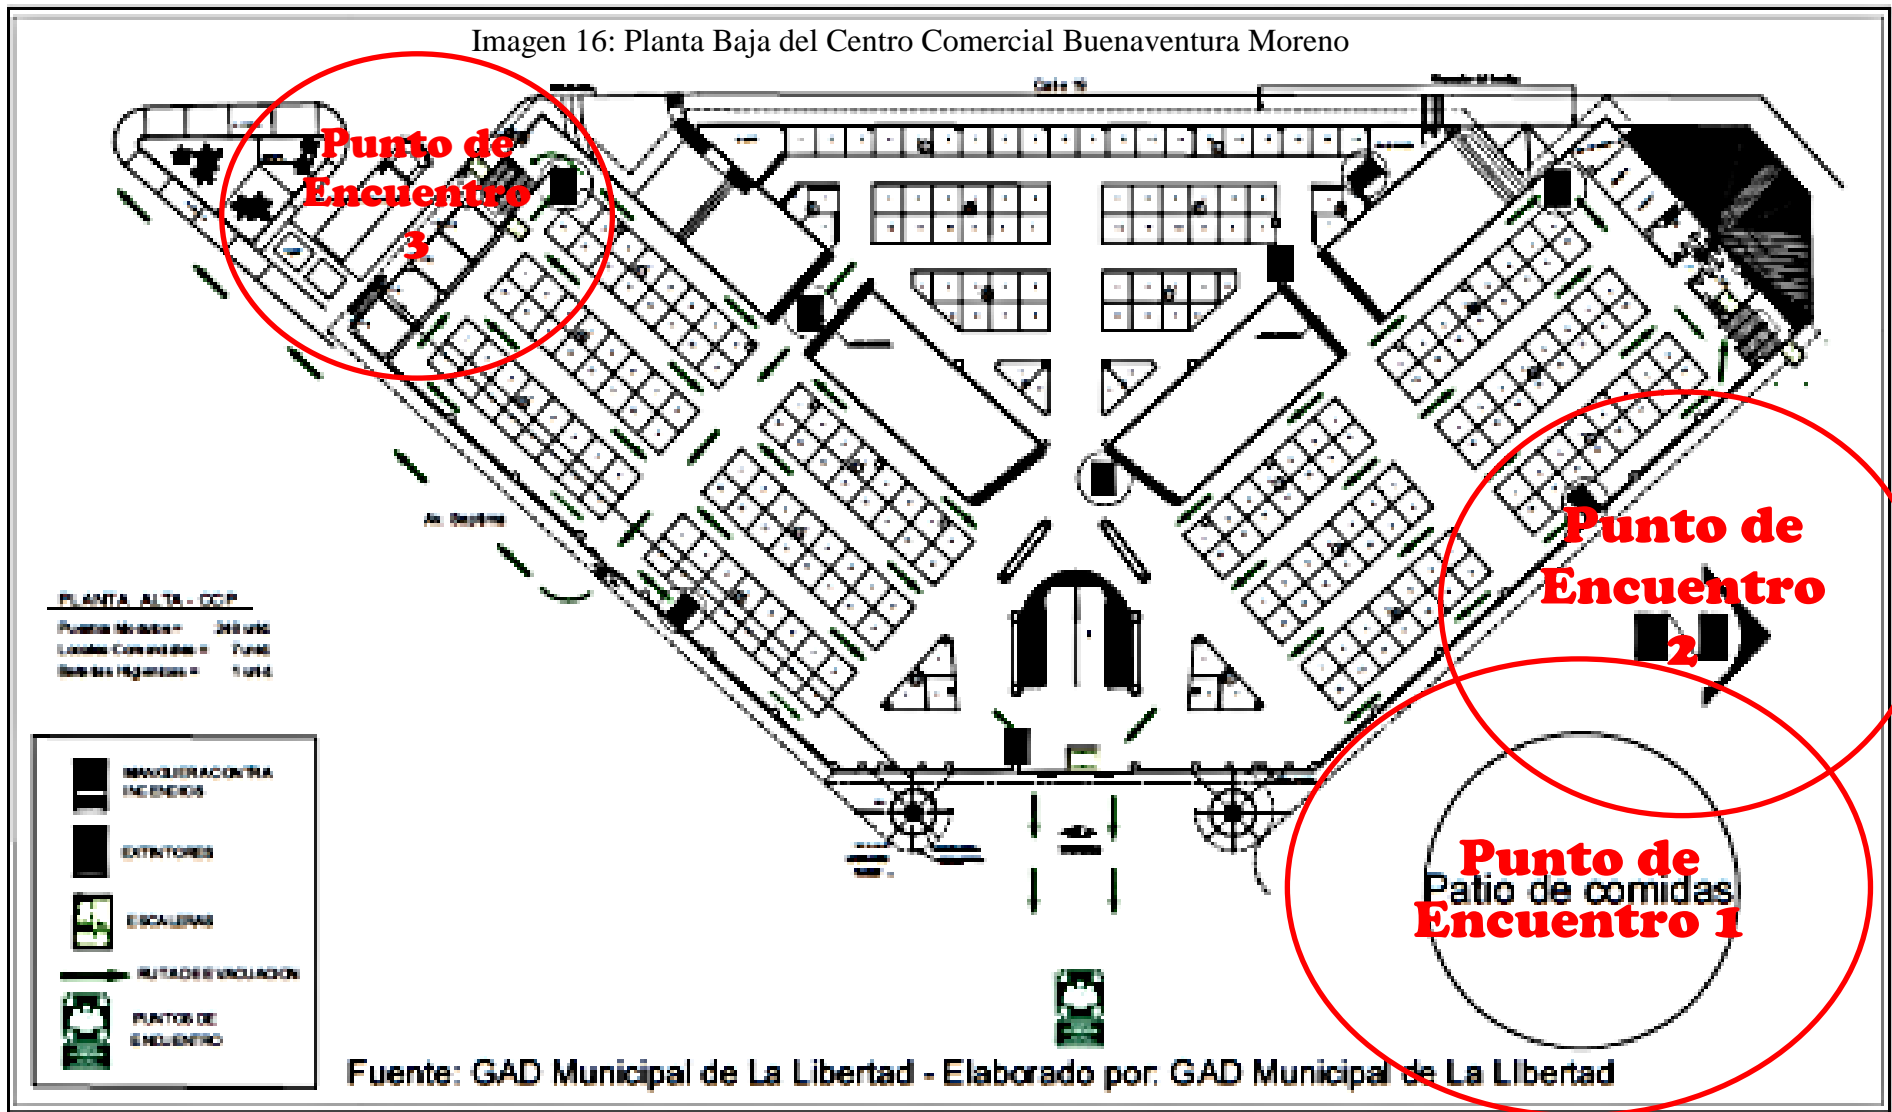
Planta Baja del Centro Comercial Buenaventura Moreno
